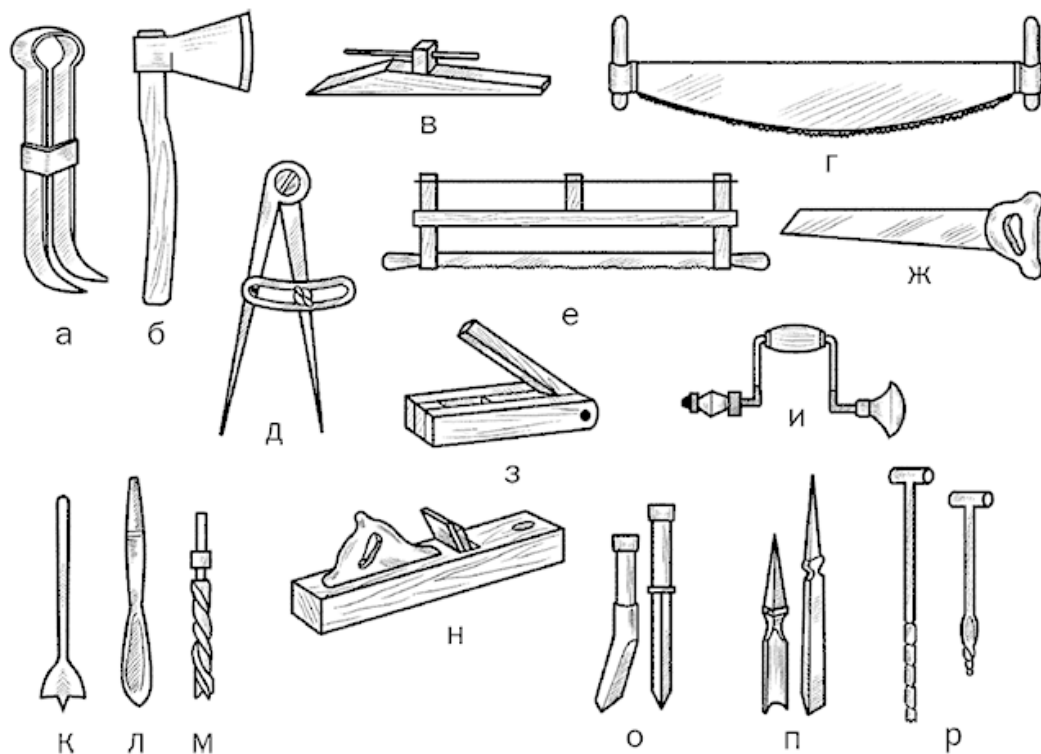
Плотничные инструменты и приспособления: а – чертилка; б – топор; в – отволока; г – поперечная пила; д – циркуль; е – лучковая пила; ж – ножовка; з – малка; и – коловорот; к – центровая перка; л – ложечная перка; м – сверло; н – фуганок; о – долото; п – стамеска; р – бурава
